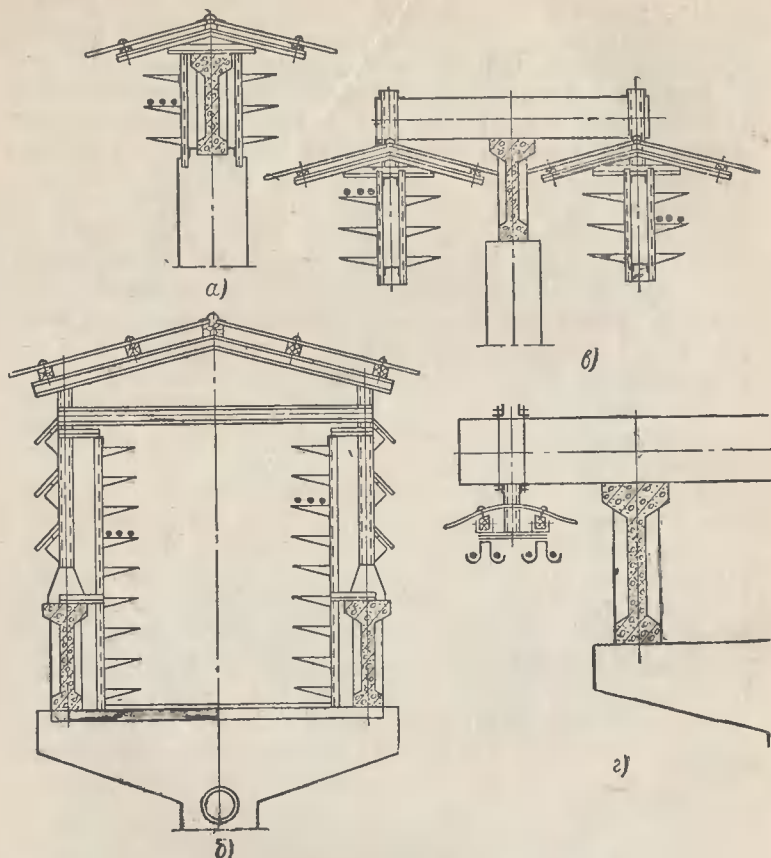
Варианты установки конструкций для прокладки кабелей по эстакадам.
